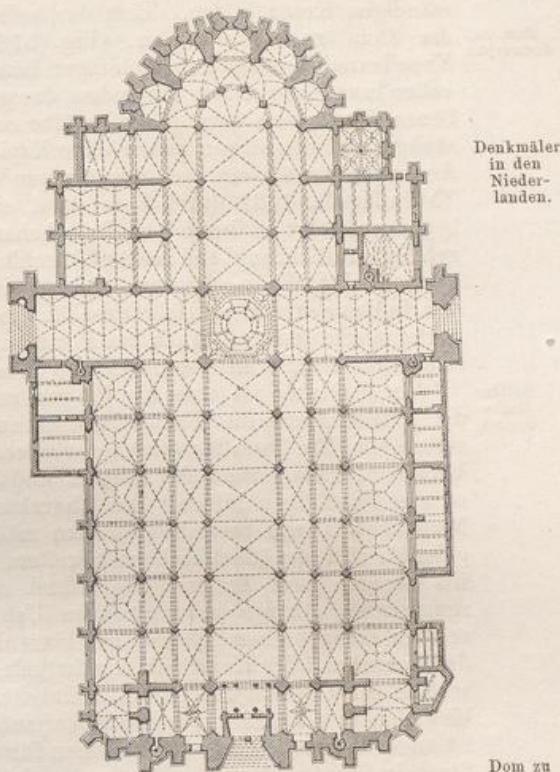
Kathedrale von Antwerpen. Grundriss.
